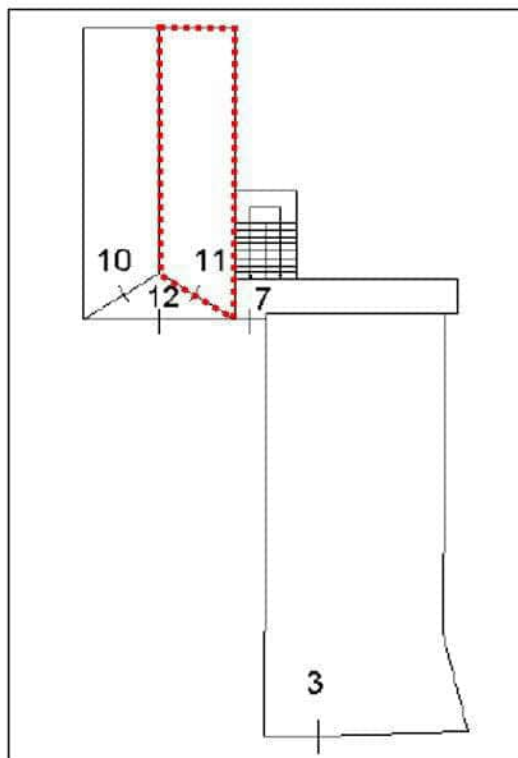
estratto dell'elaborato planimetrico della particella 308 con indicazione dell'estensione della particella 308 sub 11 autorimessa oggetto di valutazione
